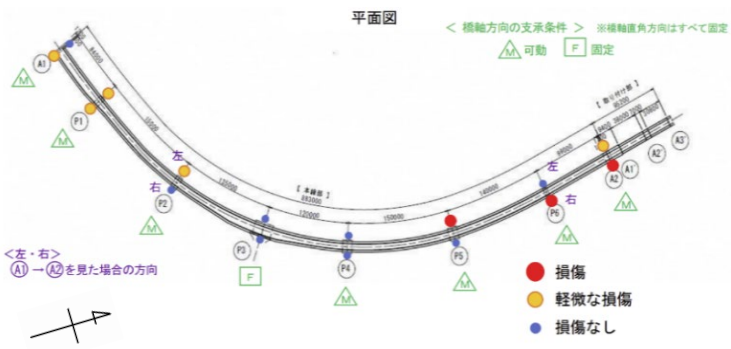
牛深ハイヤ大橋の本線部平面図および支承損傷箇所¹⁾
